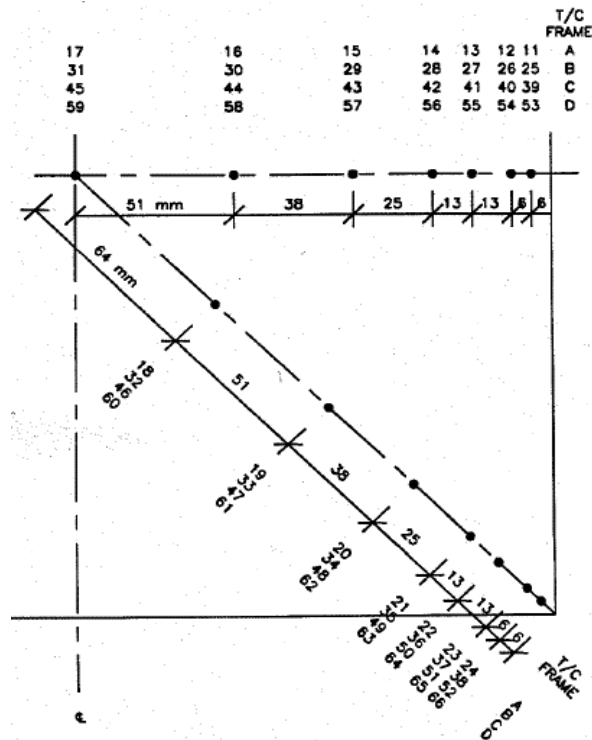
Posiciones de los termopares en las secciones A-B-C de la columna N° 1 de Lie. [56]
